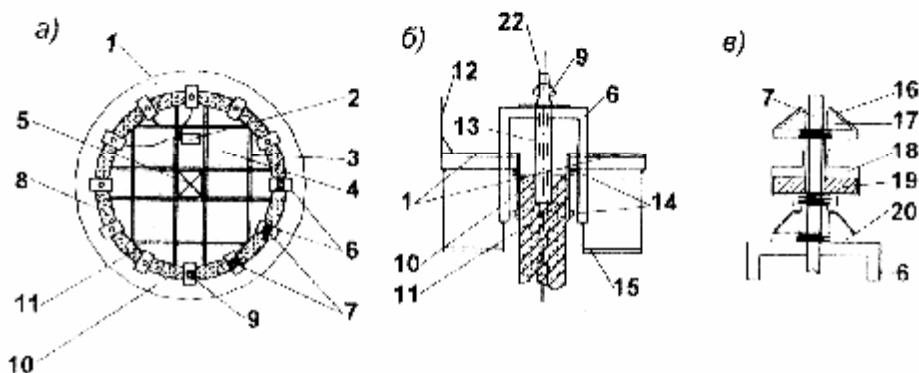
Ковзна опалубка: а – план для круглого спорудження; б – ковзне опалублення (пристрій); в – гідравлічний домкрат (0,3...5 м); 1 – робочий настил; 2 – насосна станція; 3 – прогін; 4 – настил; 5 – шахтовий підіймач; 6 – домкратна рама; 7 – домкратні стрижні; 8 – бетонна конструкція; 9 – гідравлічні домкрати; 10 – зовнішній щит опалубки; 11 – внутрішній щит опалубки; 12 – зовнішнє огороження; 13 – металева трубка; 14 – опалубні балки; 15 – підвісні риштування; 16 – верхній затискний пристрій; 17 – клиноподібний губчастий вкладиш; 18 – циліндр; 19 – поршень; 20 – нижній затискний пристрій
